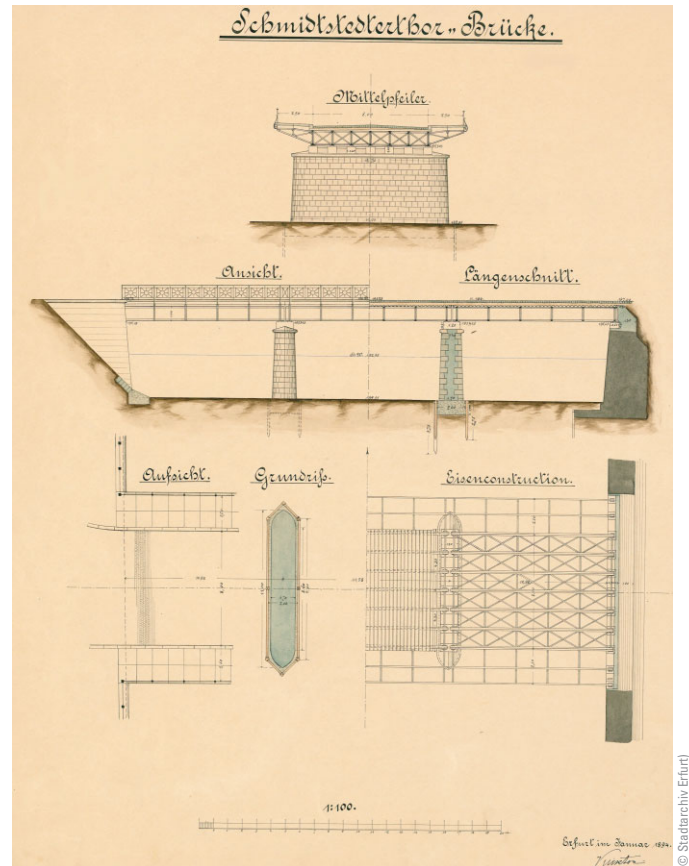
Schmidtstedtertorbrücke – Bauwerksplan – HERMANN KICKTON – 1894
